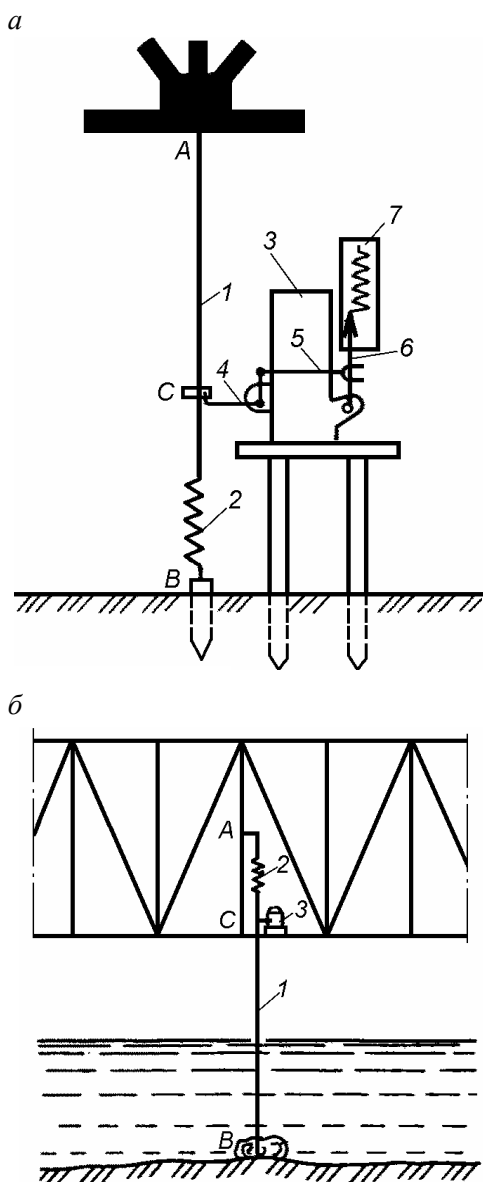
Схемы установки прибора Гейгера: а – установка на столике под пролетным строением; б – установка на пролетном строении; 1 – проволоочная связь; 2 – пружина; 3 – прибор Гейгера; 4 – Г-образный рычаг; 5 – передаточная игла; 6 – перо-рычаг; 7 – бумажная лента.
